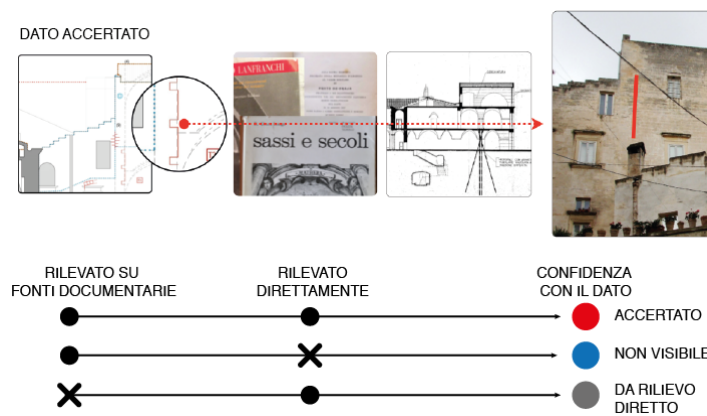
Legenda Rilievo critico, identificazione delle fonti. Ogni dato rilevato è riportato nelle piante o nei prospetti con un colore che ne attesta la provenienza.
